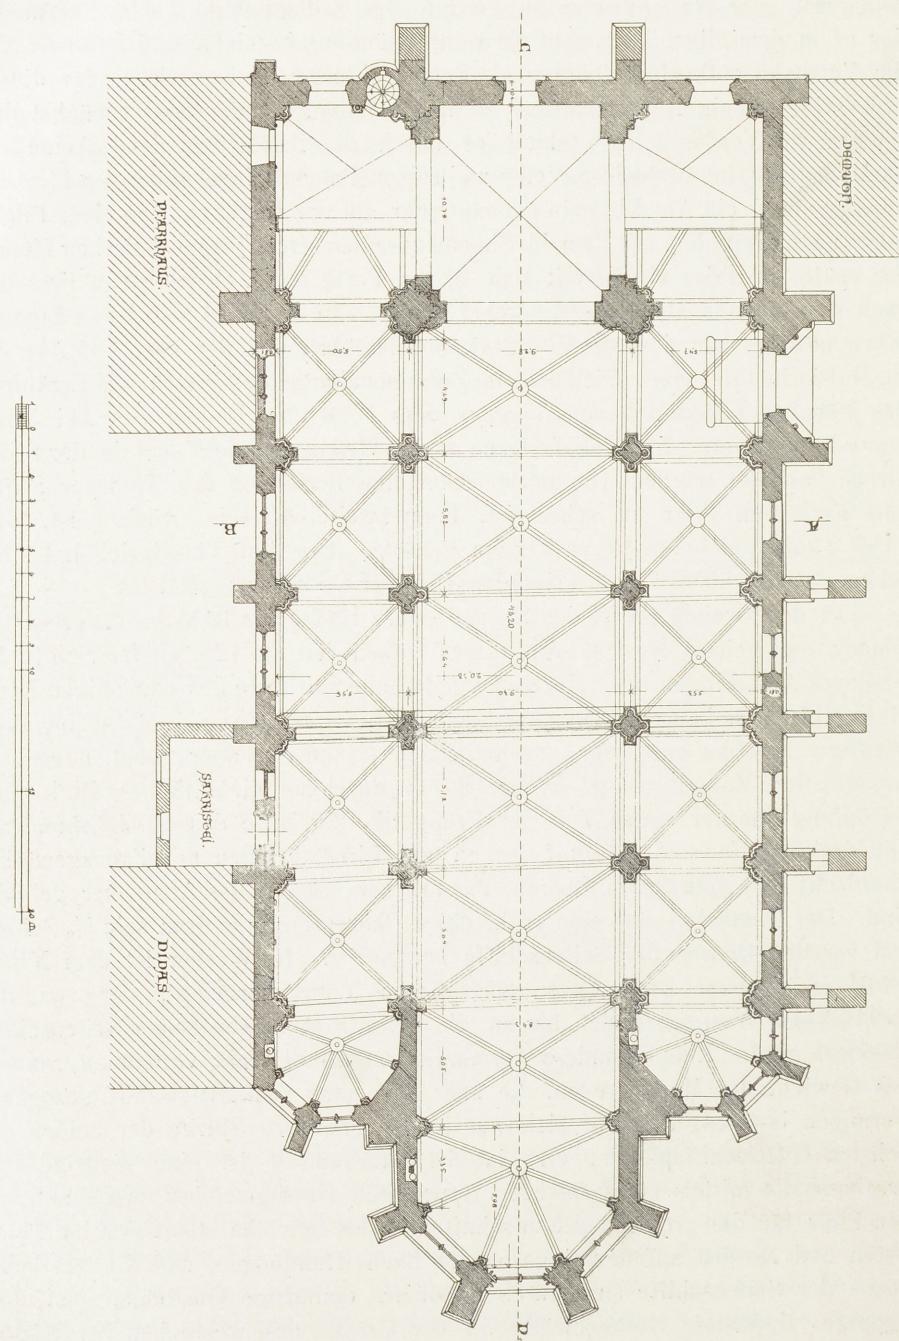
Tholey, Abteikirche. Grundriss.
